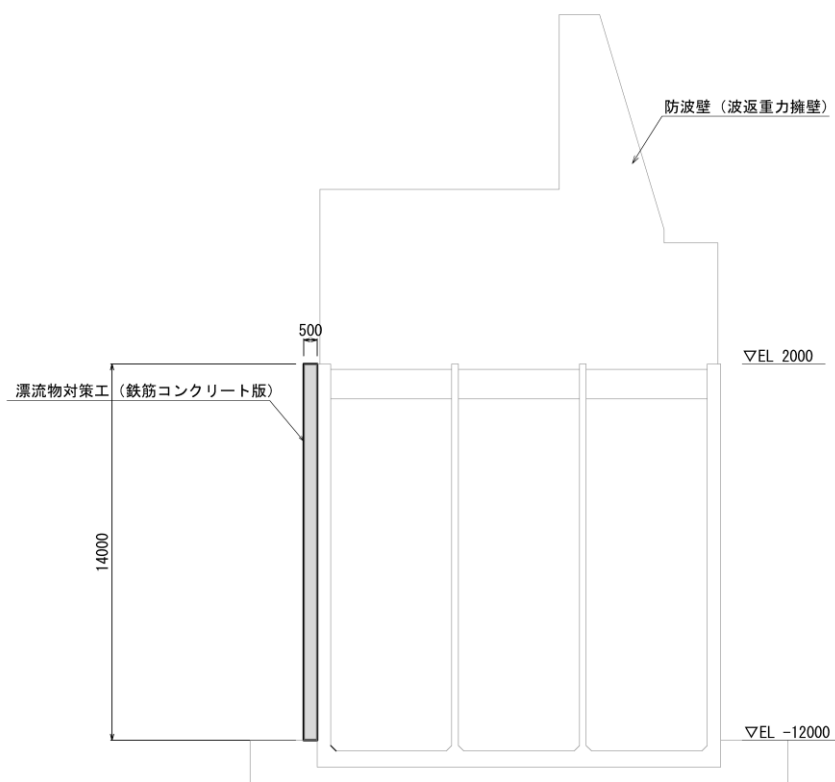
(4) 防波壁 (波返重力擁壁) ケーソンにおける漂流物対策工 (鉄筋コンクリート版) の構造概要図 (断面図)
